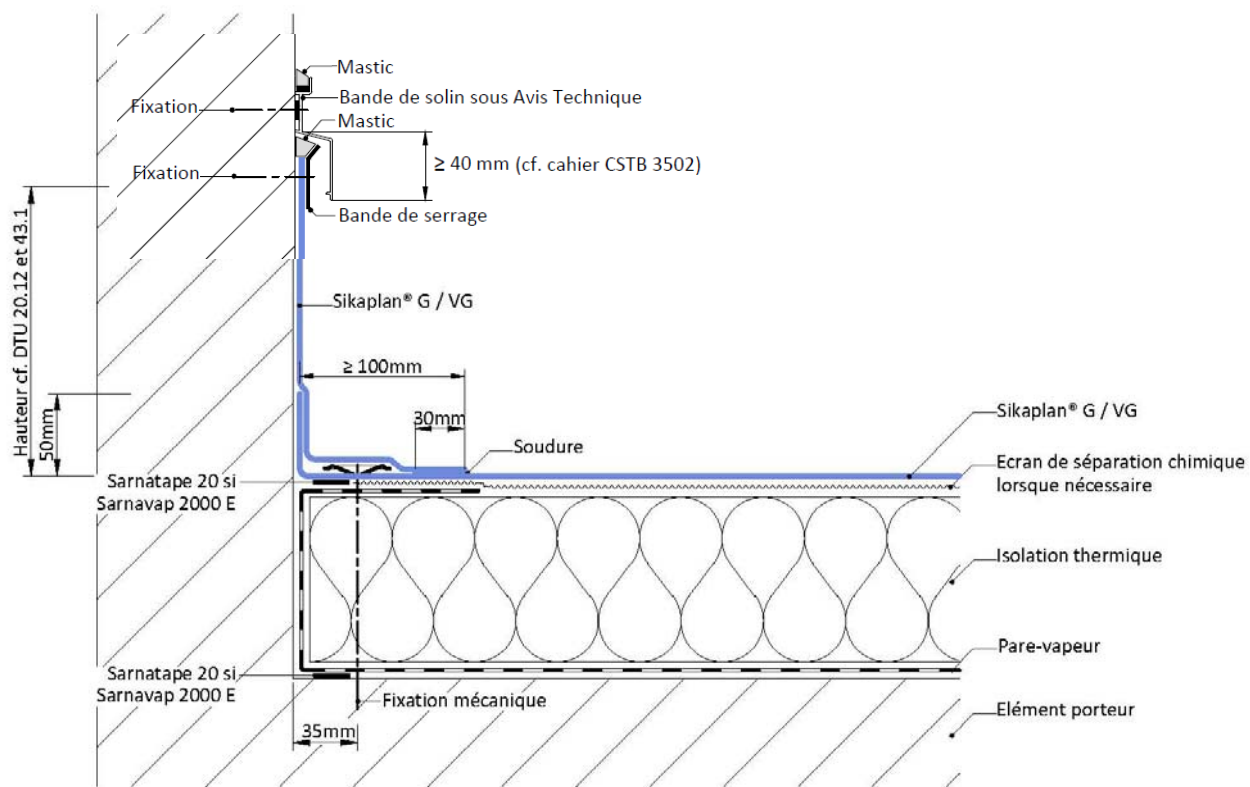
Relevé d'étanchéité sous bande de solin - Travaux neufs sur maçonnerie
